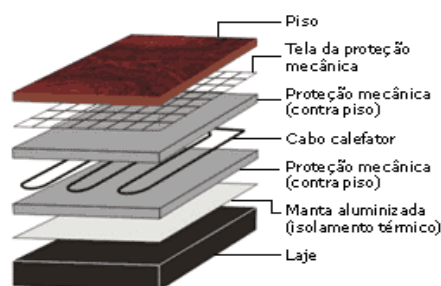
Detalhe construtivo do sistema; fonte: Hotfloor (2004)
